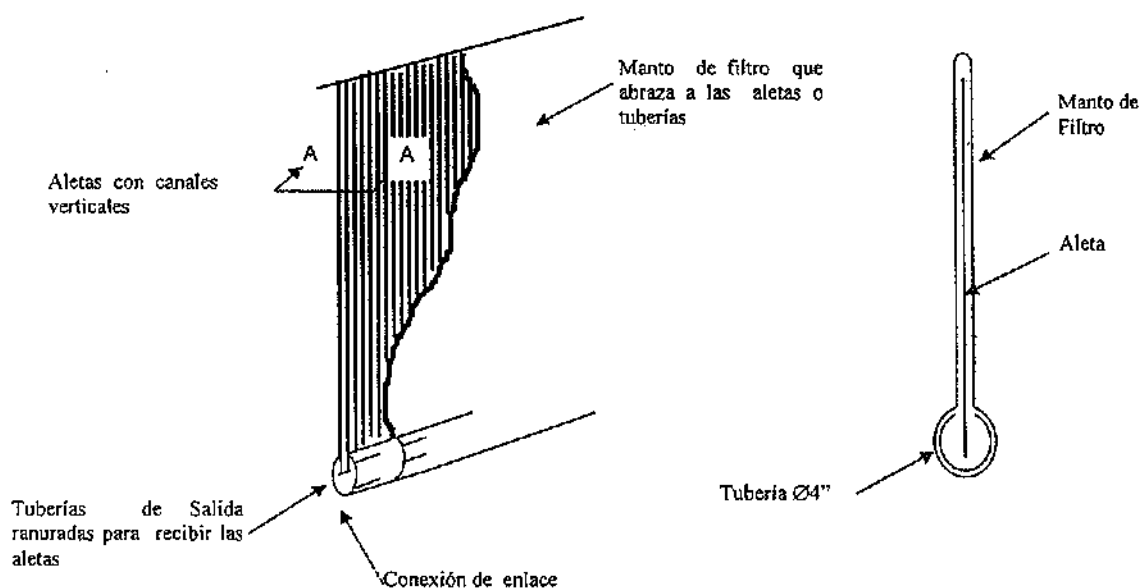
Uso de drenes prefabricados en zanjas, según Healey y Long (Huang, 1993).
